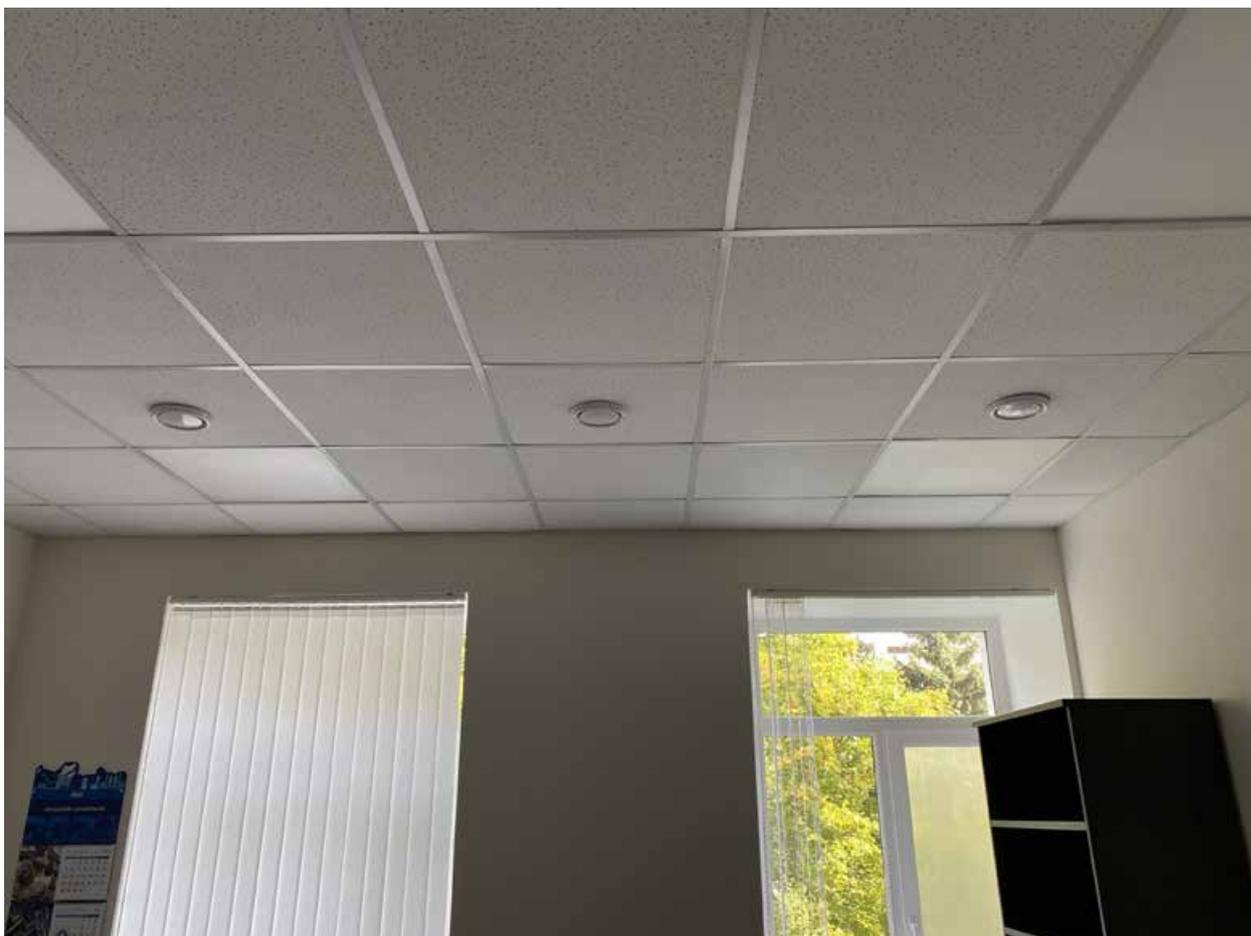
3 этаж. Помещение 6-Н(6-10).
